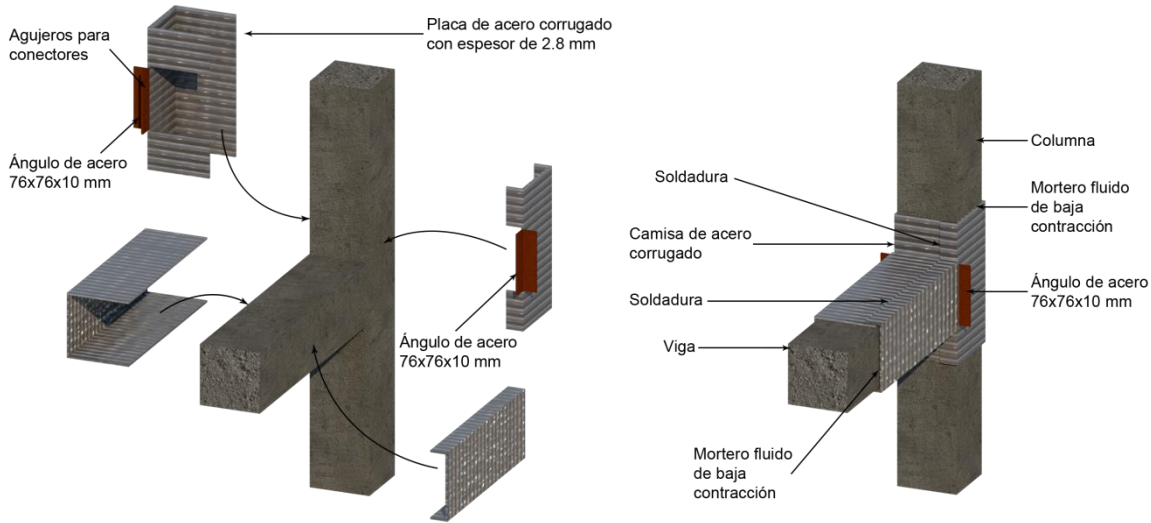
Ensamblado esquemático de placas para un encamisado de nudo. Fuente: Elaboración propia, con base en Ghobarah et al., 1996.
